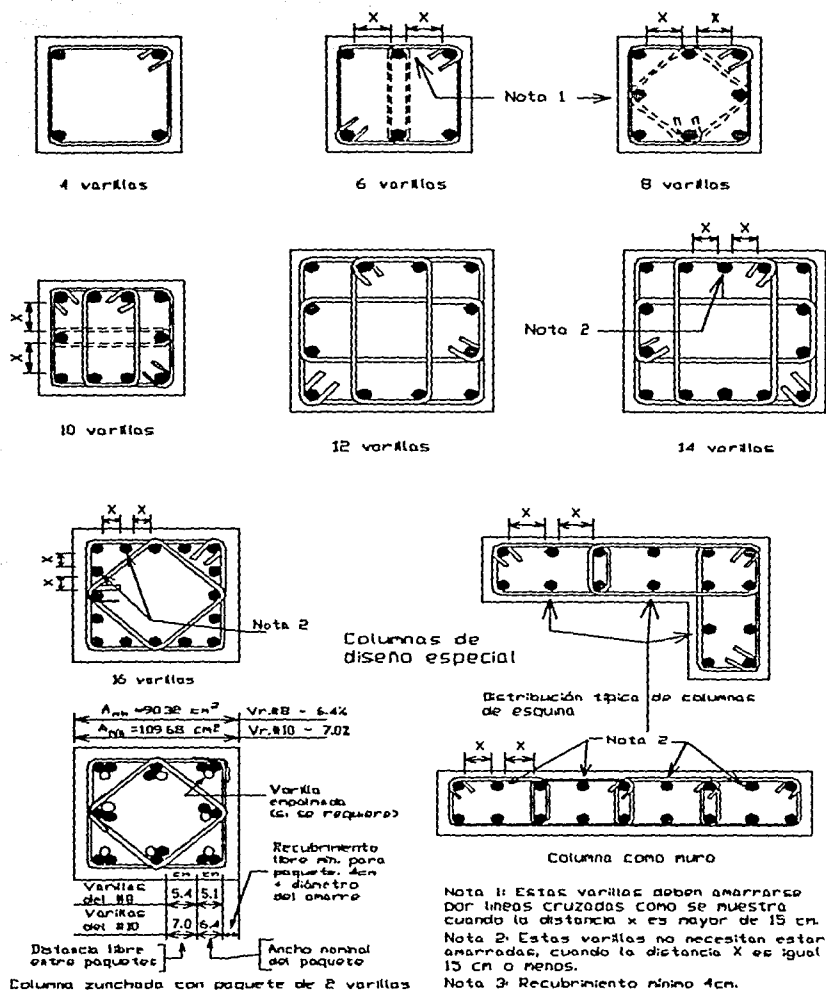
Amarres de columna de una pieza aplicable para rejillas prearmadas con empalmes traslapados. (1.7)
